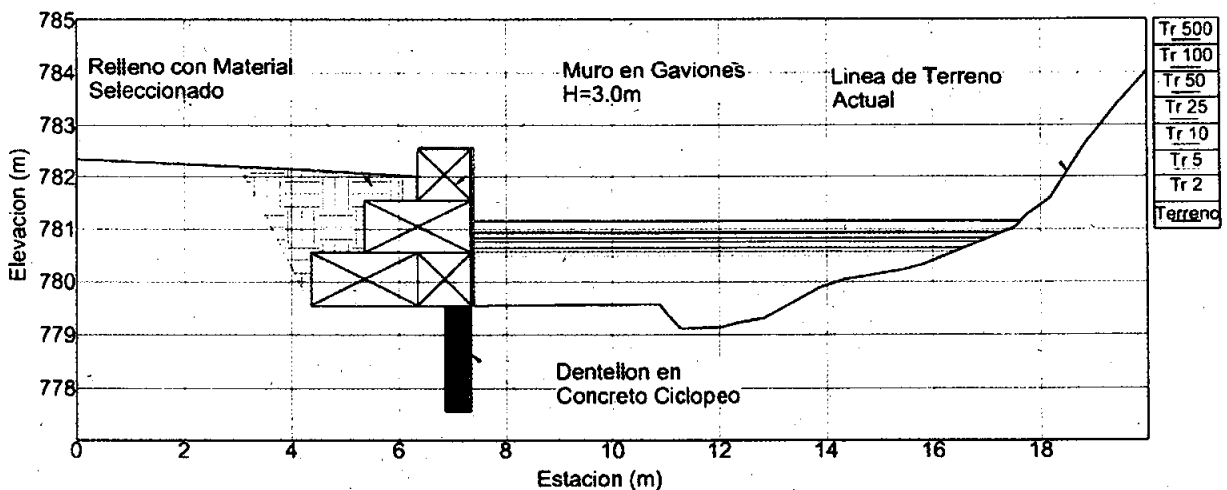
Perfil sección con muro en gavión y dentellón en concreto ciclopeo
